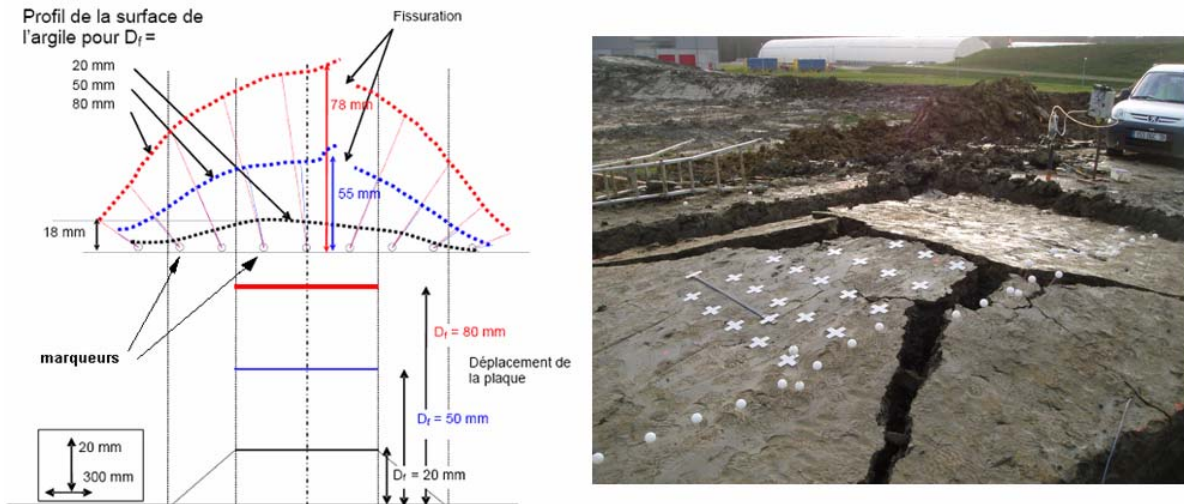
Evolution du profil vertical de la planche d'essai T3
